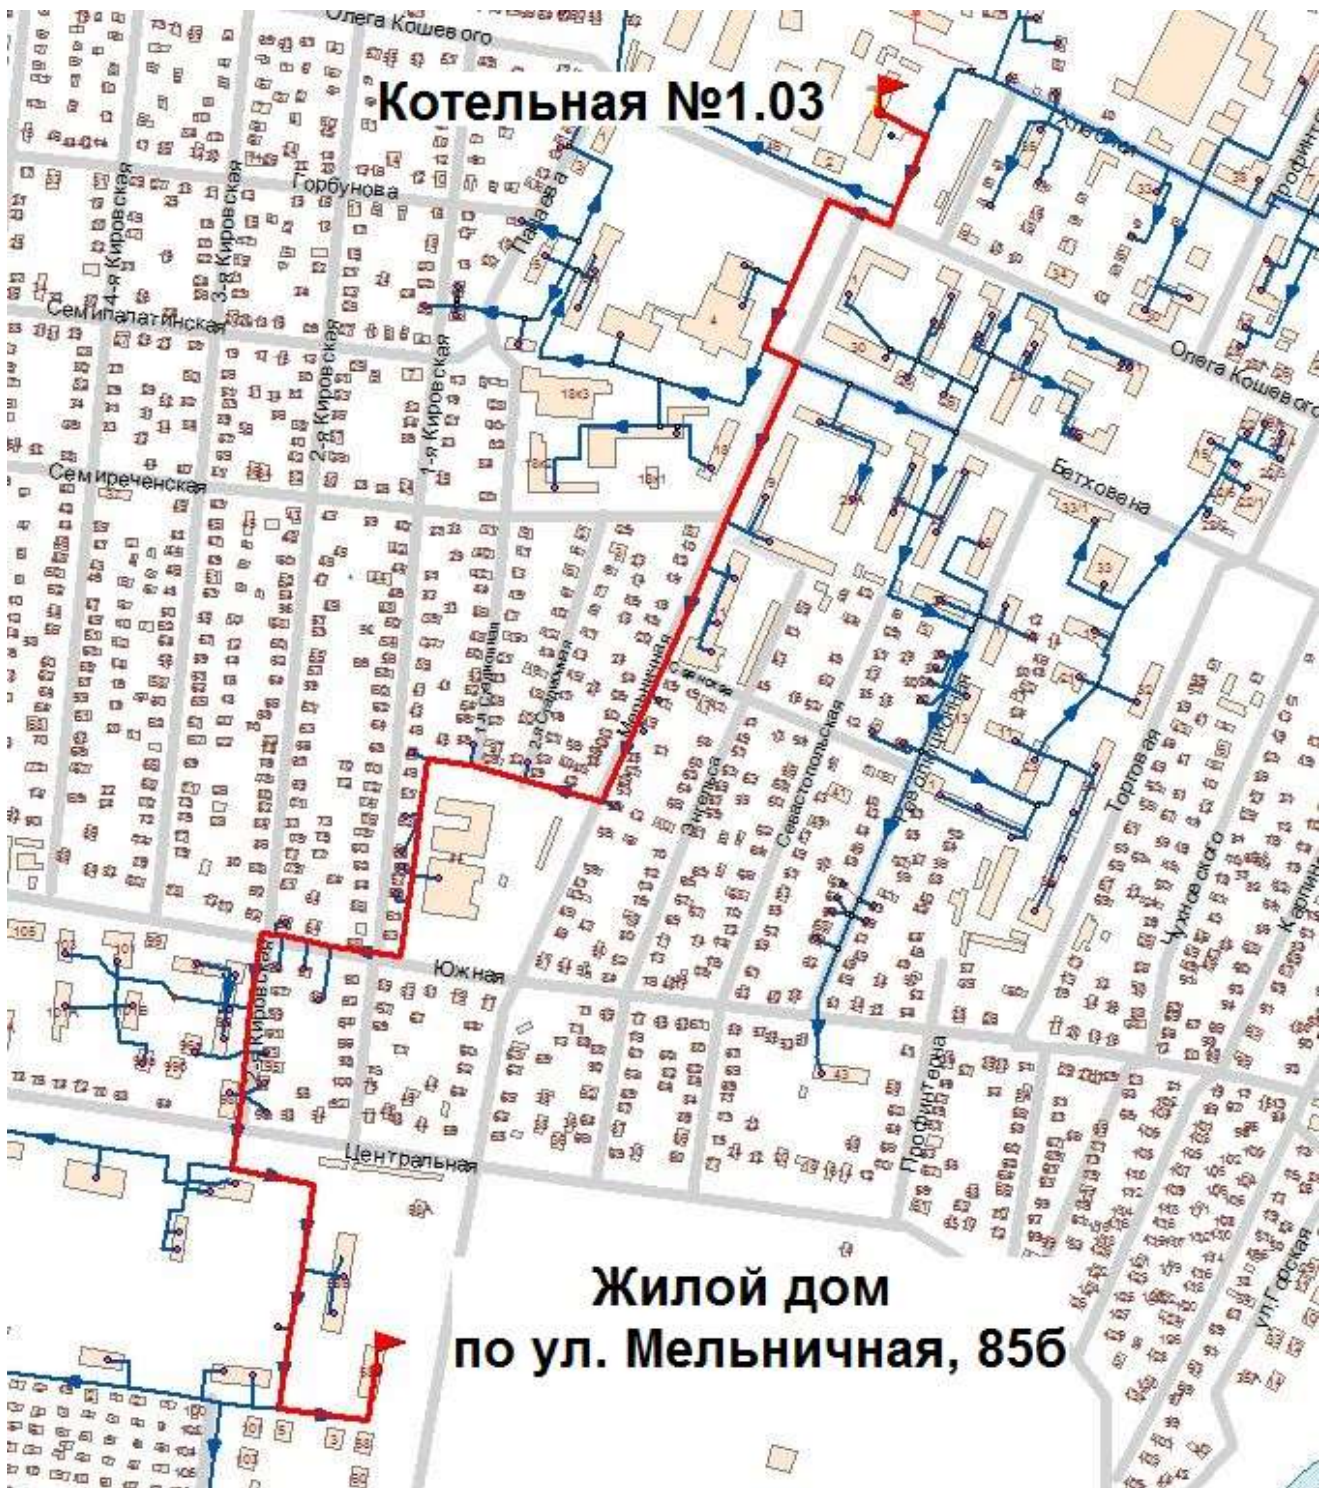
Трассировка теплопровода от Котельной 1.03 до жилого дома по ул. Мельничная, 586
